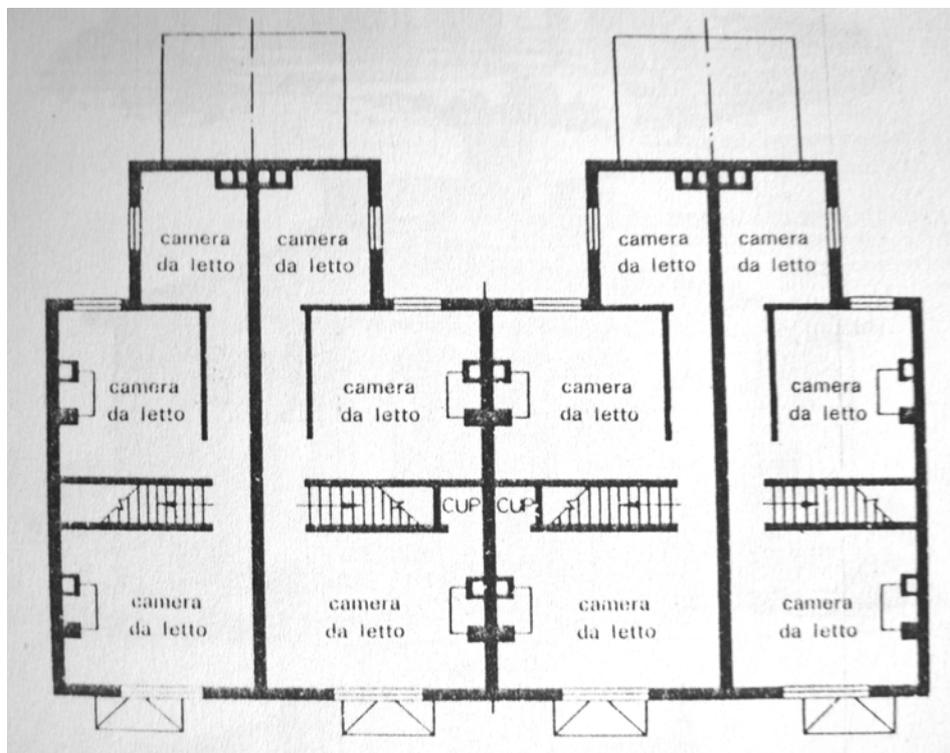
Plantas baixas do segundo pavimento de casas em fileira inglesa, conforme os regulamentos de 1875
